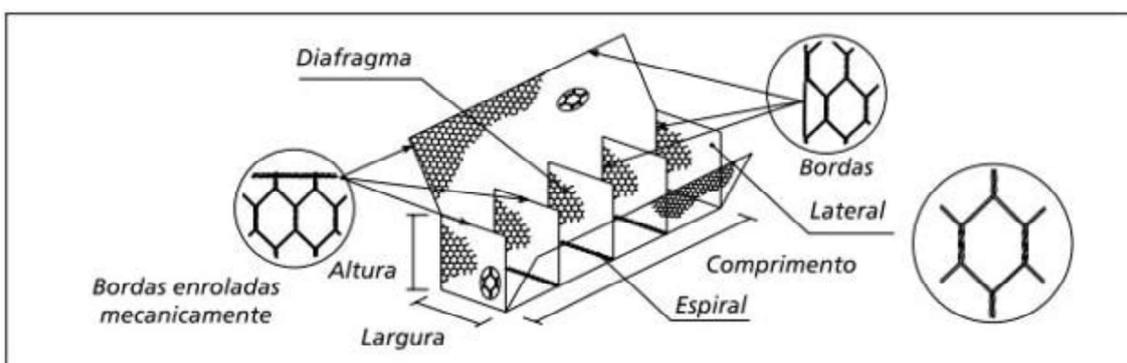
Muro de gabião tipo caixa(detalhamento)
